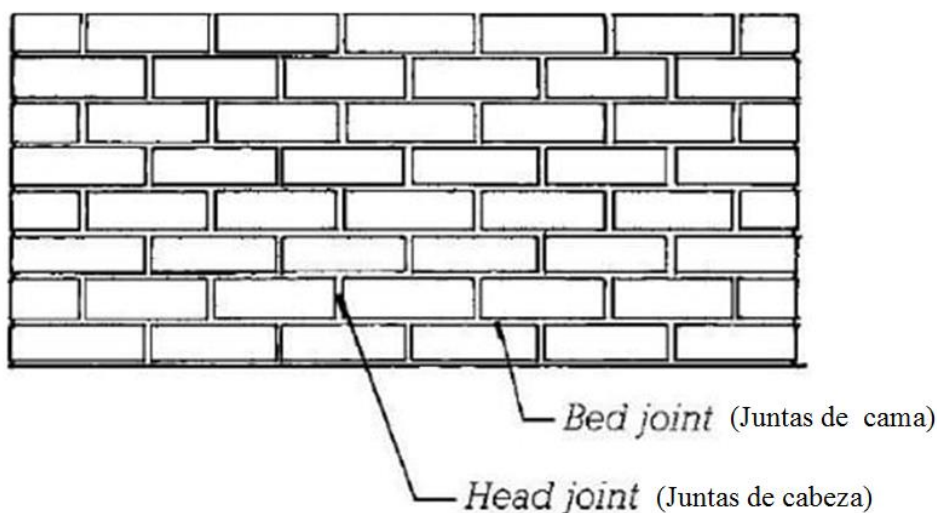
Juntas de cabeza y cama en muro de mampostería de hormigón armado. Fuente: (“Types of Masonry Walls in Building Construction,” n.d.)
